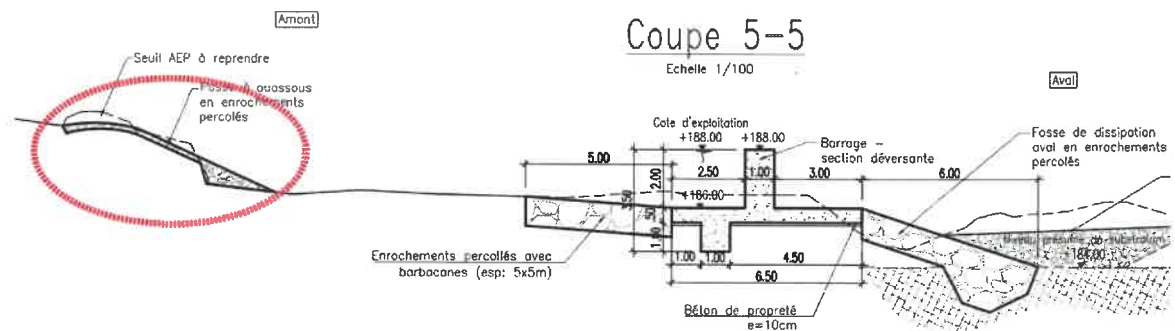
vue en coupe de l'implantation de la passe à ouassous sur l'ouvrage existant
